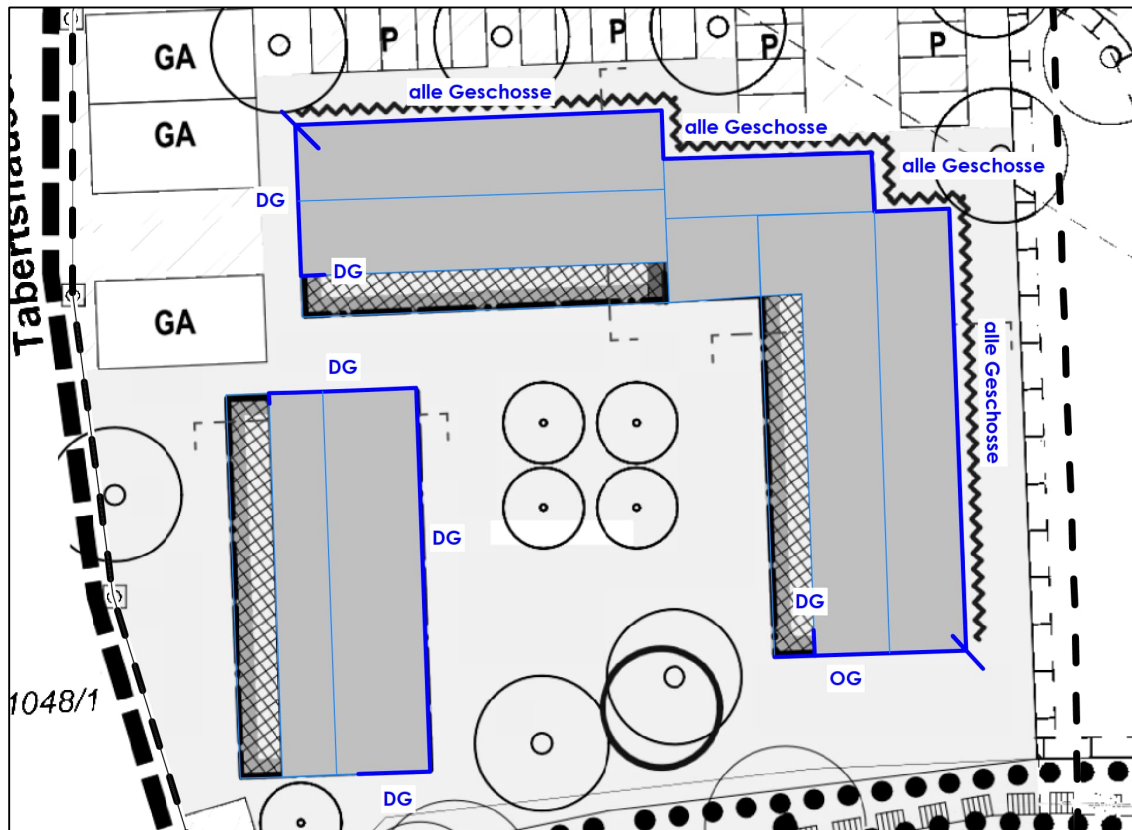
Darstellung der Fassaden, an keine öffenbaren Außenbauteile zu Schlafräumen zu liegen kommen dürfen
